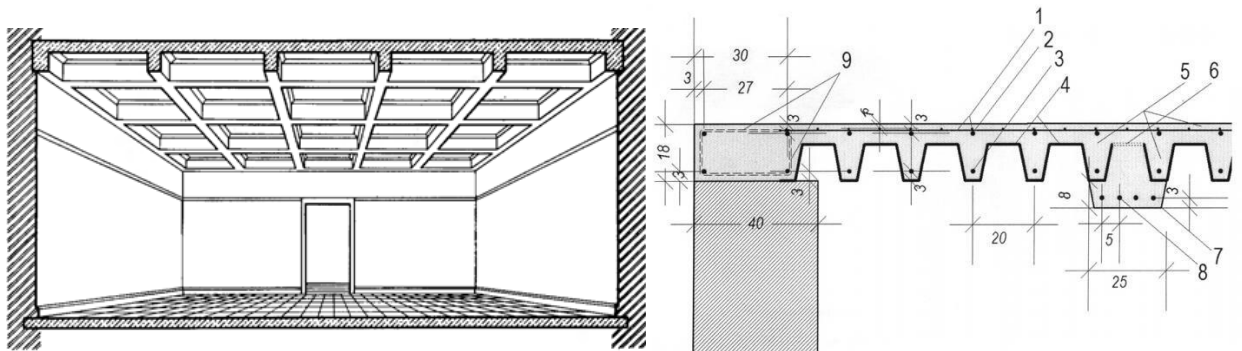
Кесонні перекриття: 1- сітка сварна, 2- верхнє армування, 3- нижнє армування, 4- несучий профнастил, 5- бетон на гранітному щебні, 6- віддалена частина верхньої горизонтальної полки профнастилу, 7- підбалка, 8 – арматура періодичного профілю, об'ємний каркас
